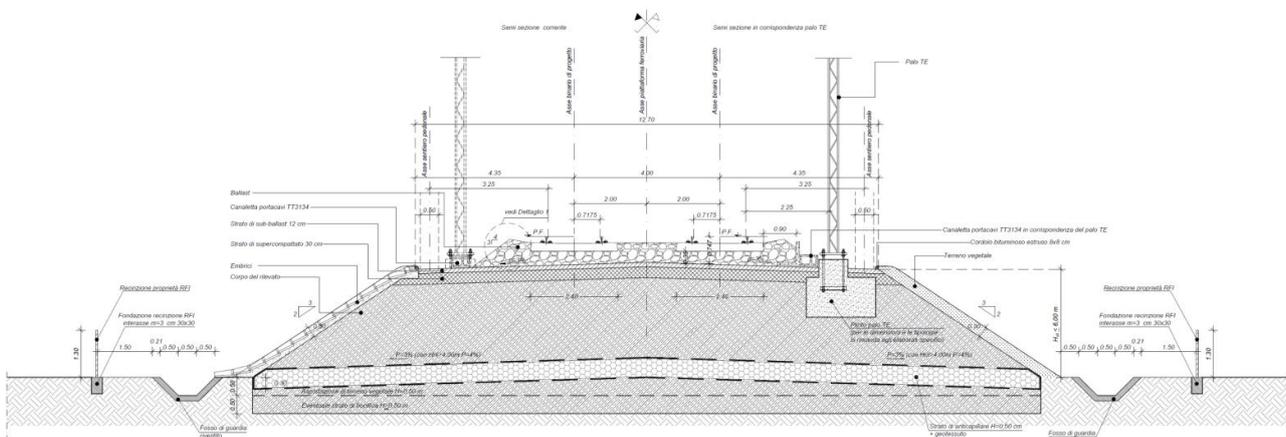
Sezione tipo ferroviaria in rilevato a doppio binario (piattaforma in retto) con  $H_{rl} \leq 6,00$  m
